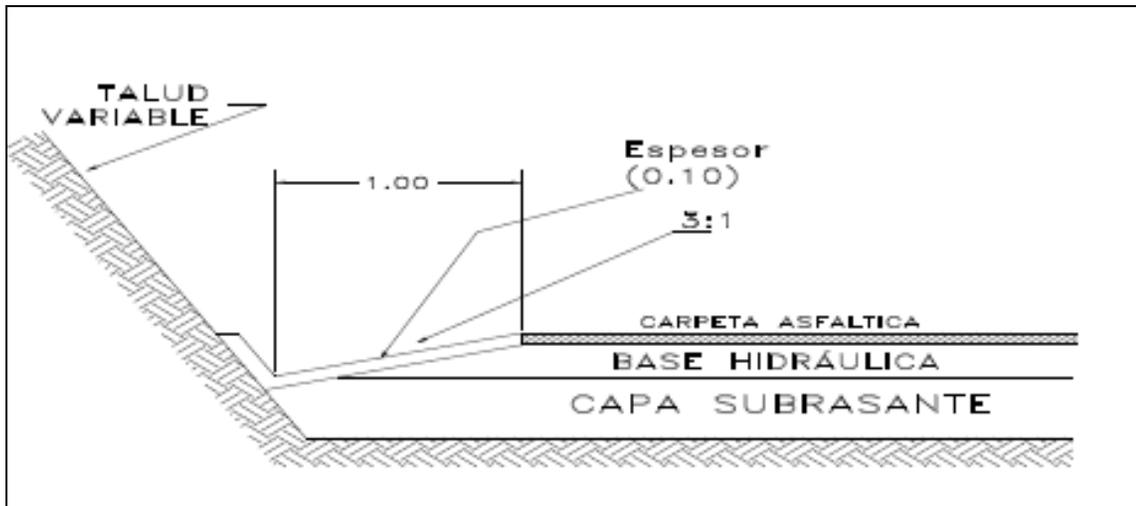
Cuneta con corte en balcón (adaptado de SCT e IMT, 2000.).
